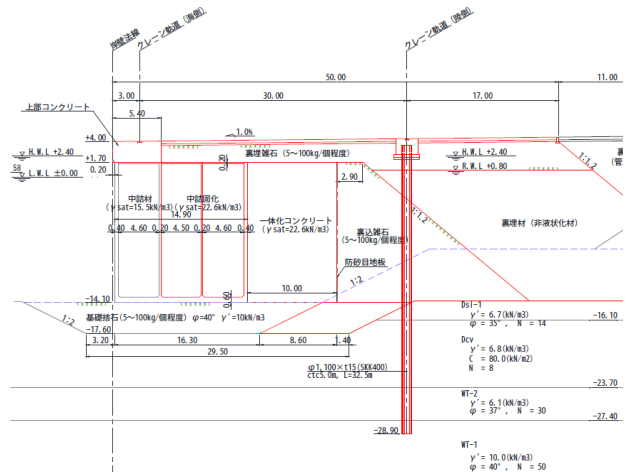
比較断面図（一体化コンクリート工法（既設堤体背後））
